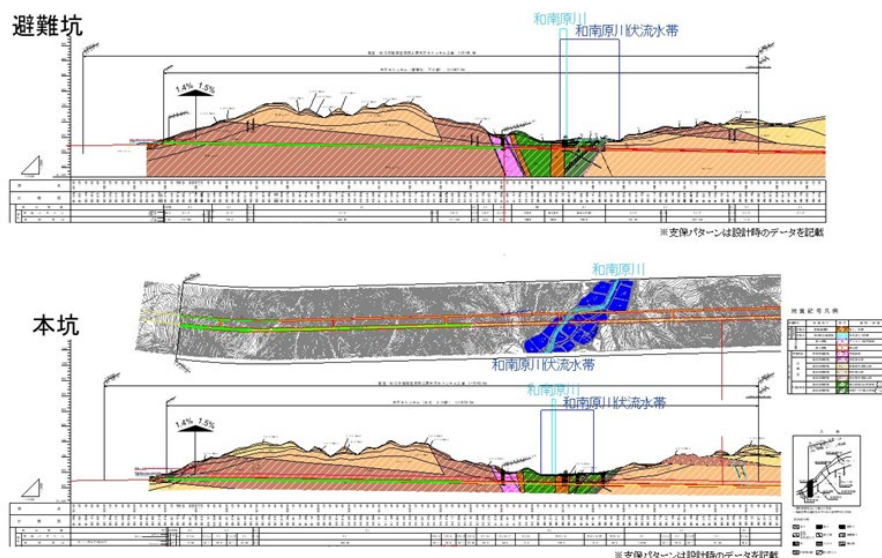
大万木トンネルの平面図、縦断面図(中国地方整備局資料)
